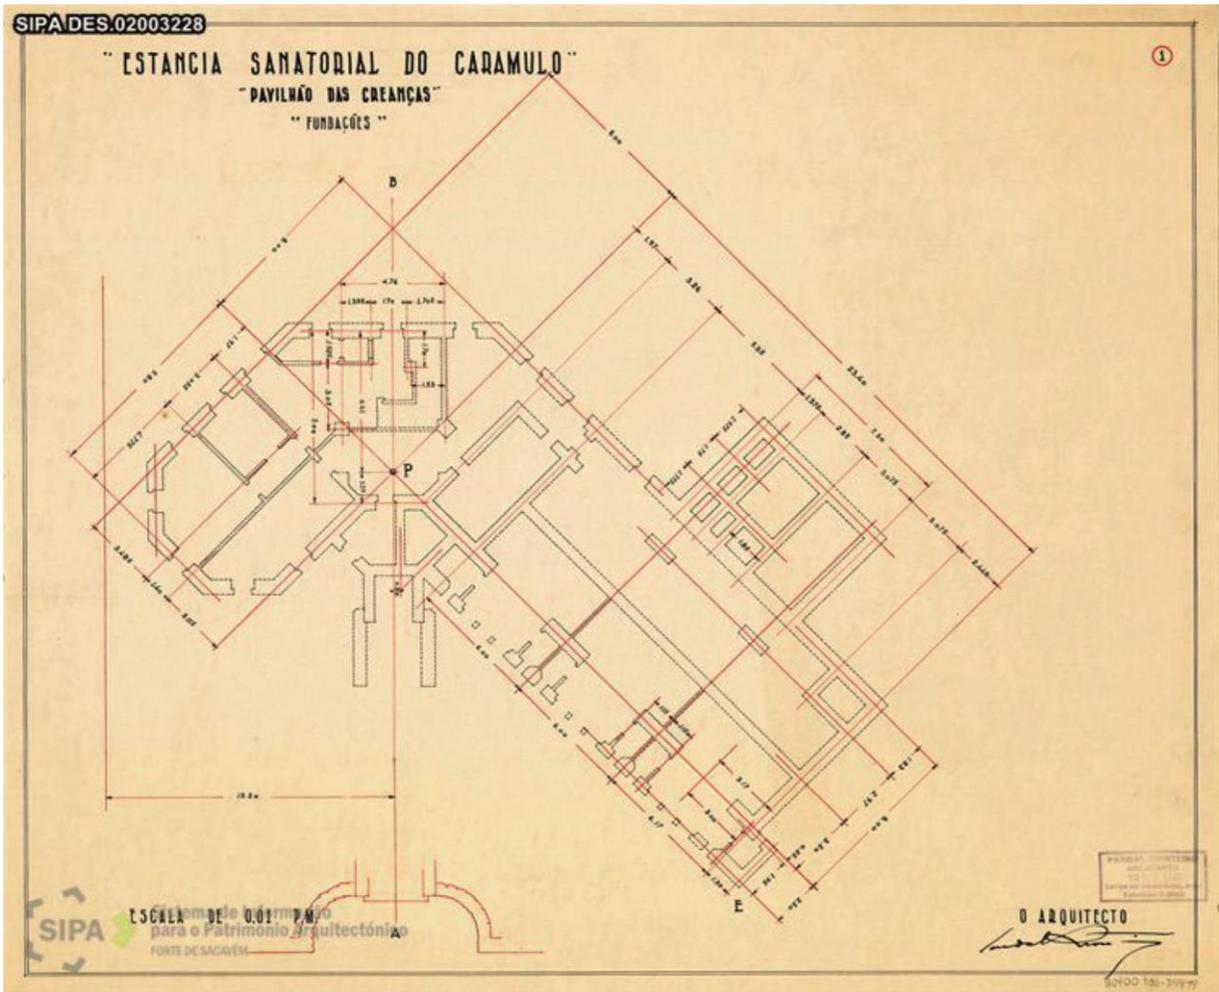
Planta Fundações – projeto de Pardal Monteiro
